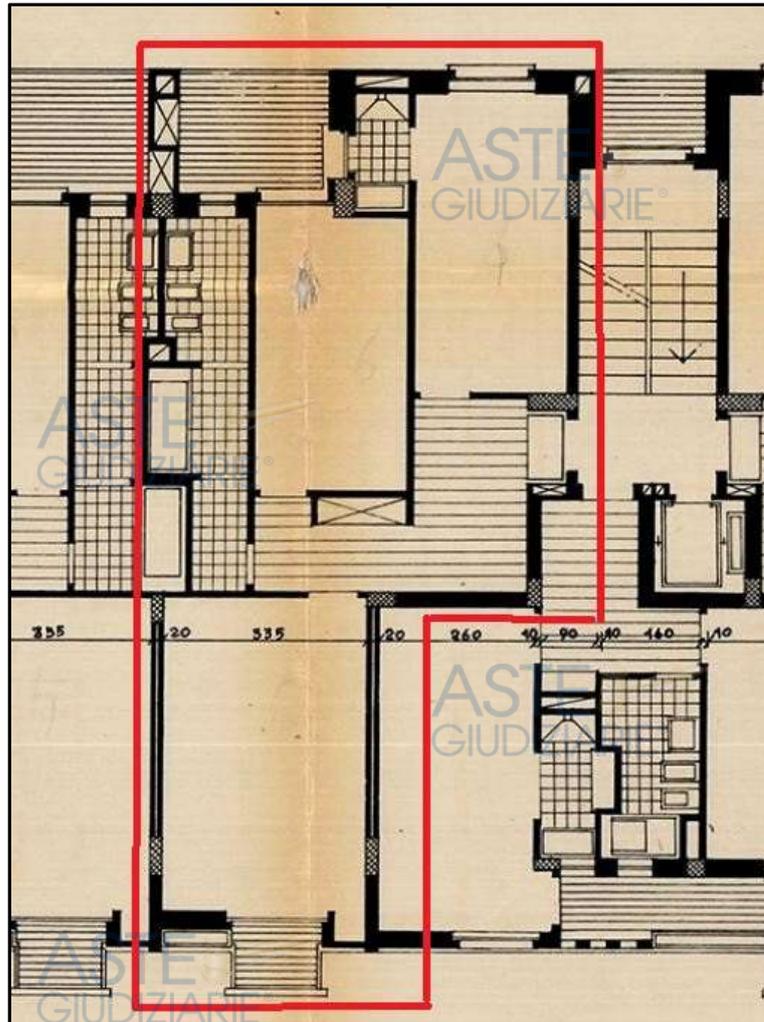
Estratto planimetria piano terzo (4° p.f.t.) licenza 11094 del 1958
